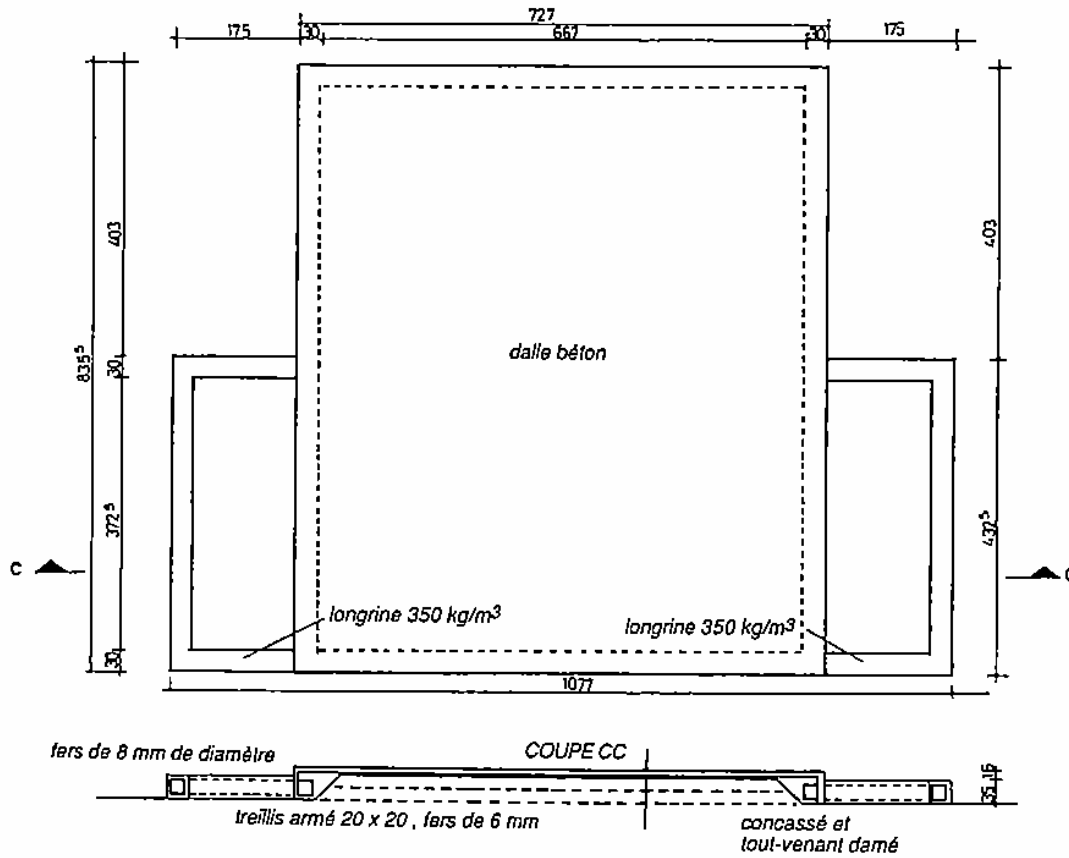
Plan des fondations avec solutions en radier sur remblai compacté et longrines périphériques en béton armé.
